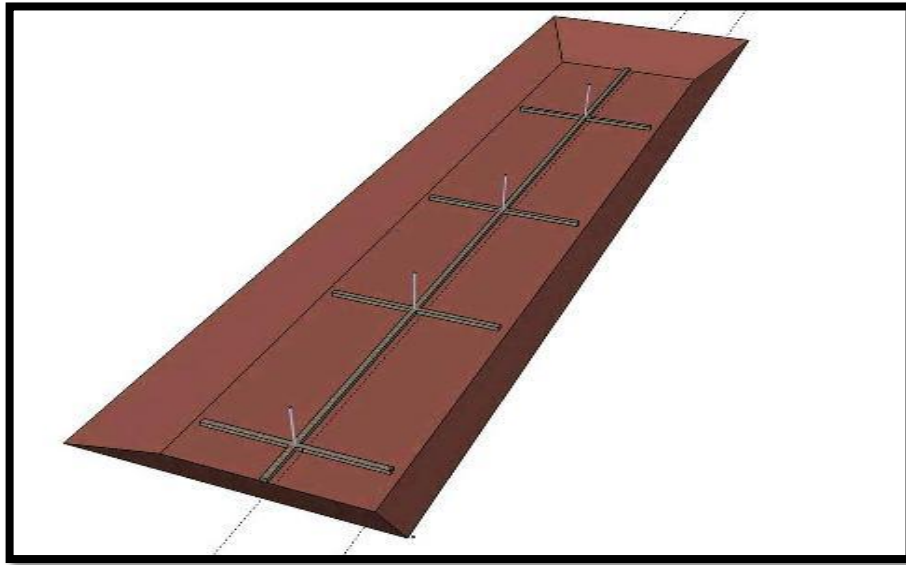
Detalle de construcción de filtros e inicio de construcción de chimenea
